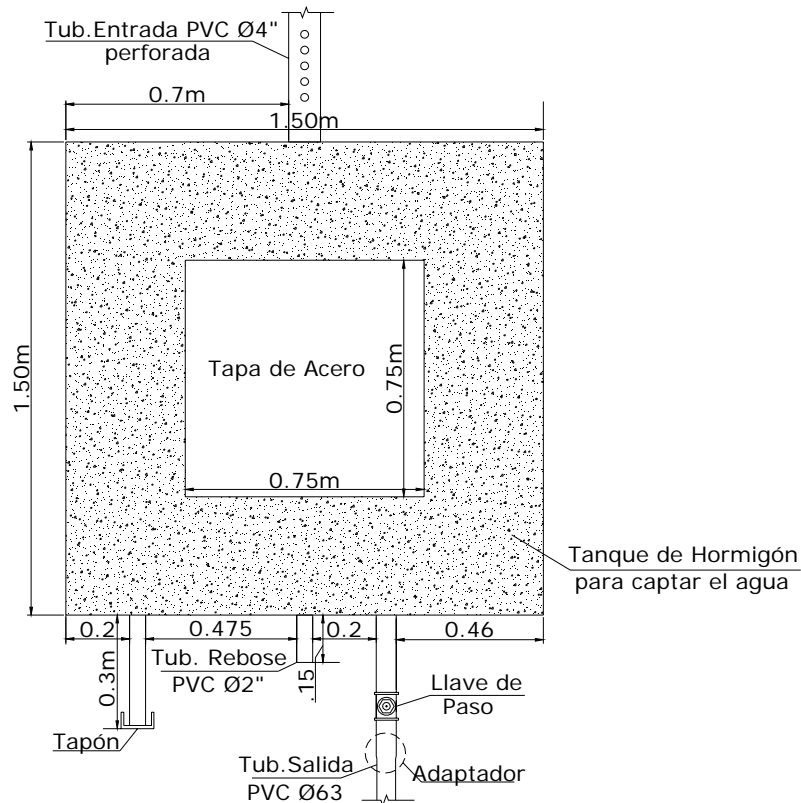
Vista en planta del tanque de presión de la captación 3.
